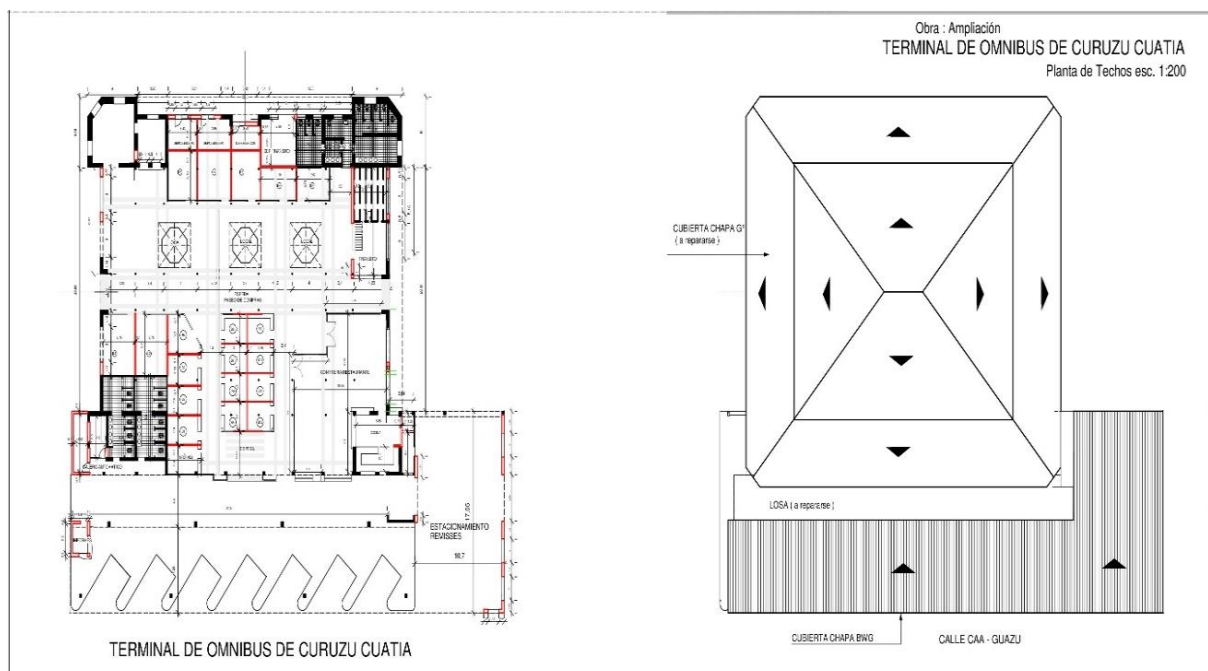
Planta de la terminal existente en Curuzú Cuatía
